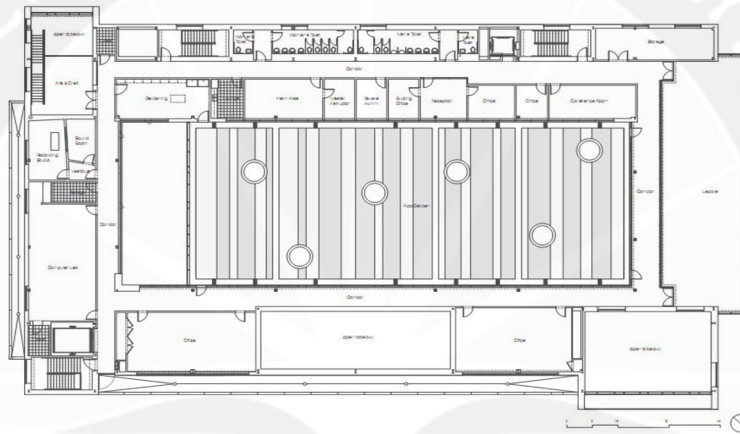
Site Plan Gary Comer Youth Center
